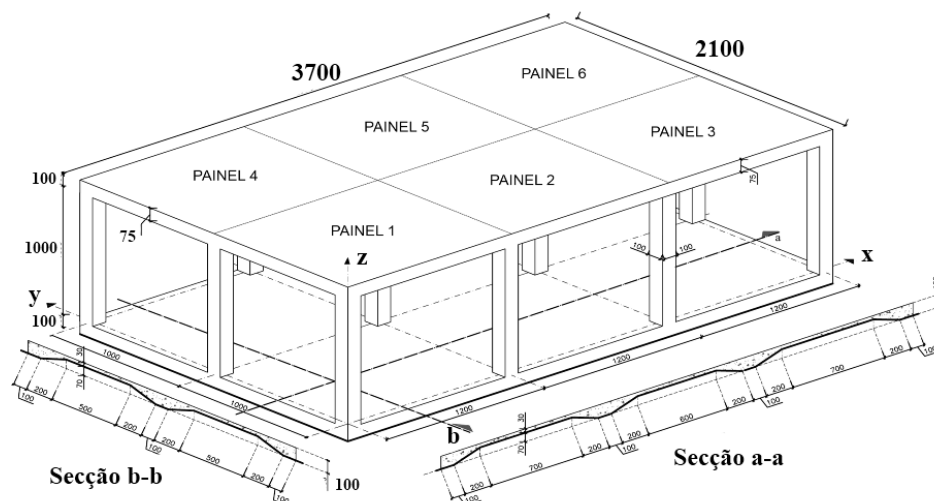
Geometria do protótipo construído em BACRFA (dimensões em mm).
